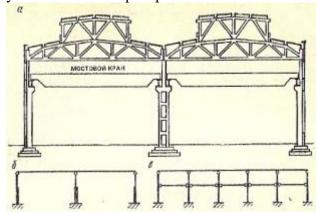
Одноэтажное промышленное здание с мостовыми кранами:
